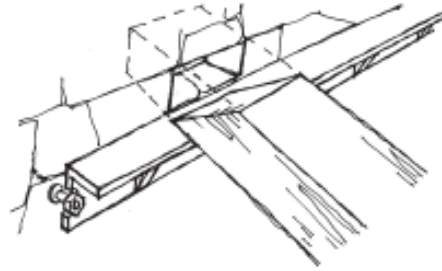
Apeo cabeza de viga con viga carrera apoyada sobre ménsulas de piedra.
